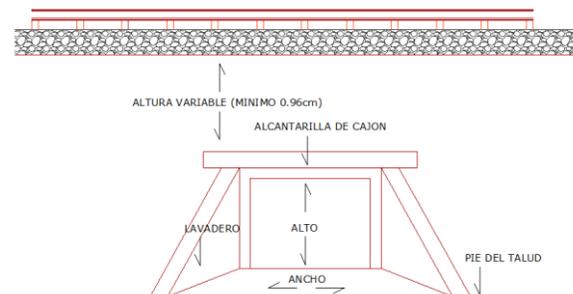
Detalle de alcantarilla sección cuadrada. (Fuente: Autor)
